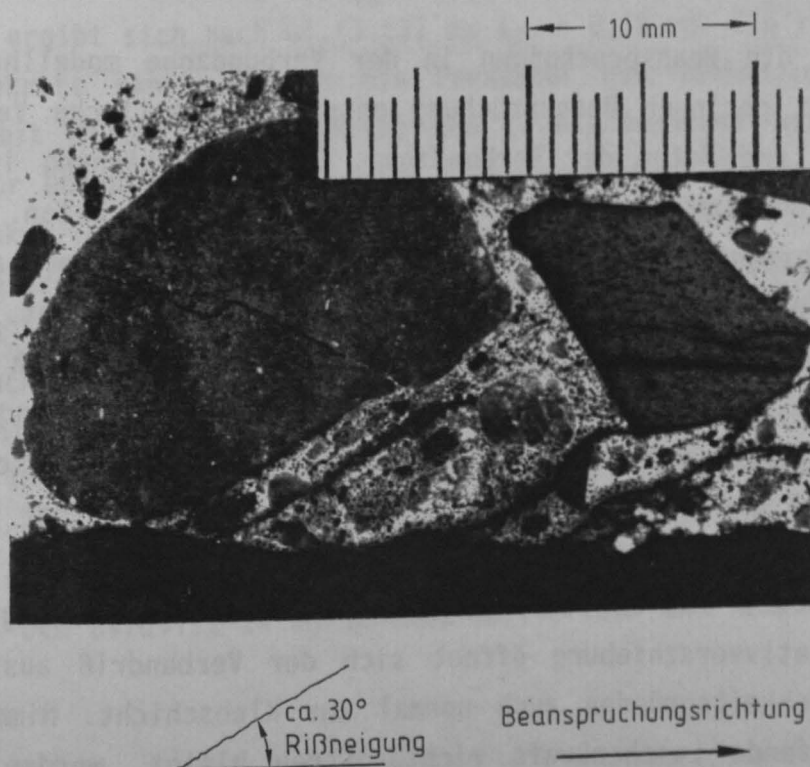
Rißbildung im oberflächennahen Beton (Detail A)
